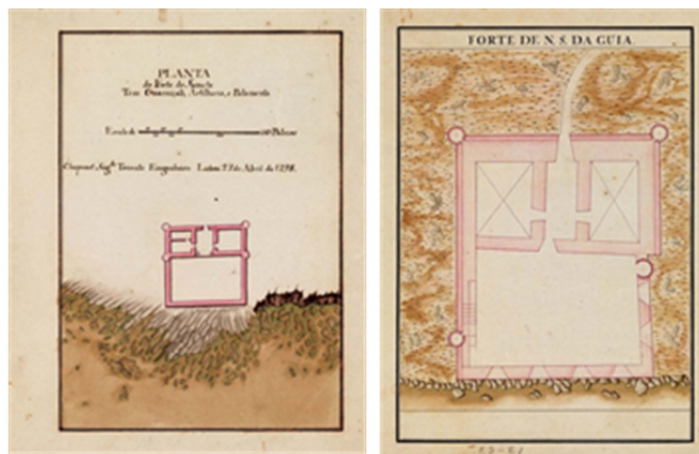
Planta dos fortes de Sanxete 1798 e de N.^a S.^a da Guia. Plantas de geometria quadrangular. (GEAEM cota: 3571-3-31-43 Chapuset e cota: 3560_III-3-31-43, Maximiano Serra)
